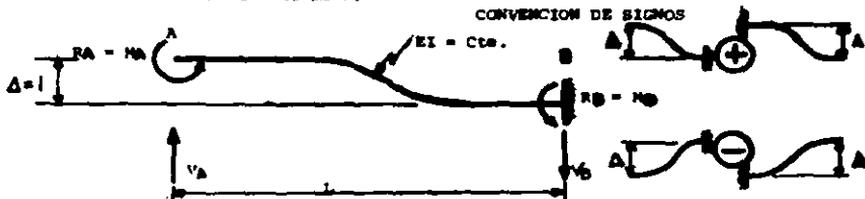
Rigidez lineal de una barra empotrada en el extremo B.
